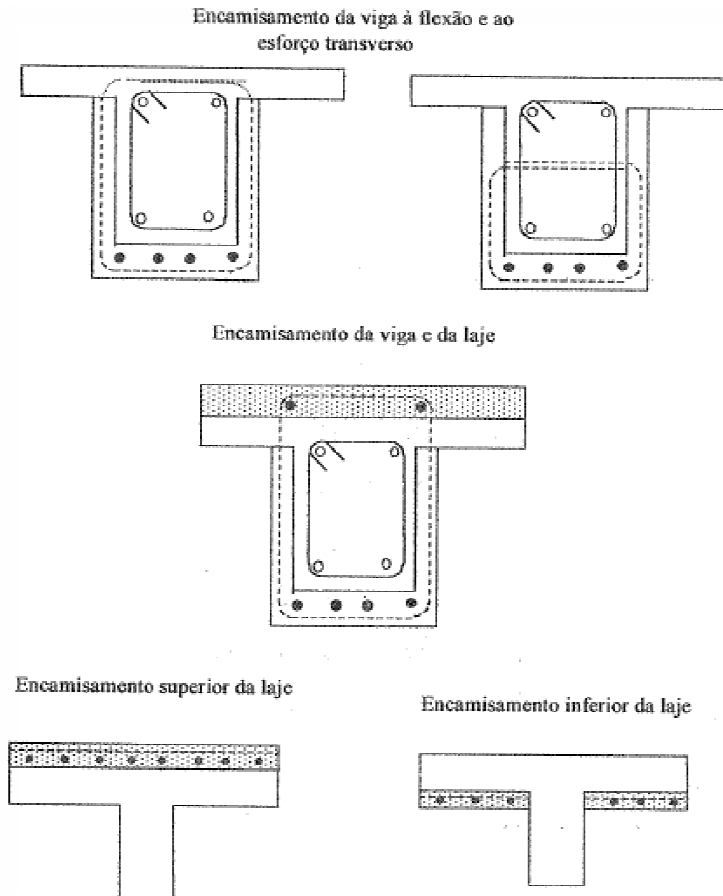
Representação esquemática do encamísamento com betão de vigas e lajes (Carreira, 2000).
